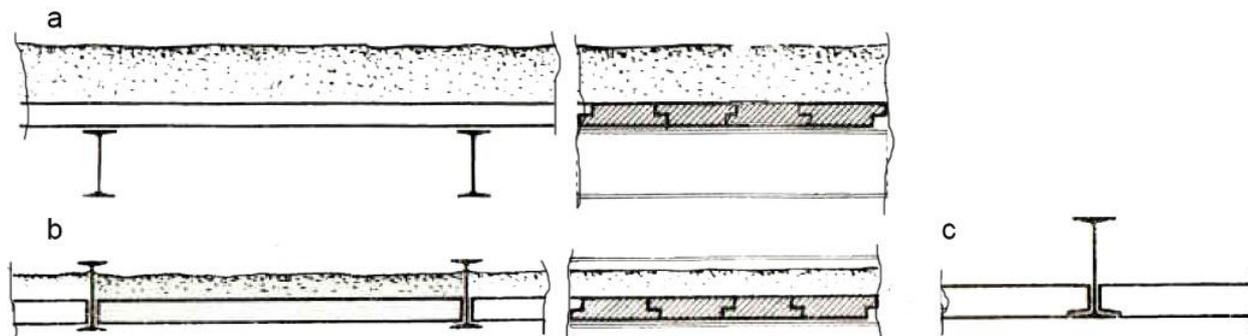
Черный пол в перекрытиях по металлическим балкам: а – простильный черный пол чердачного перекрытия; б – наборный черный пол междуэтажного перекрытия; в – стык подбора и металлической балки с подрезкой доски подбора [33]
